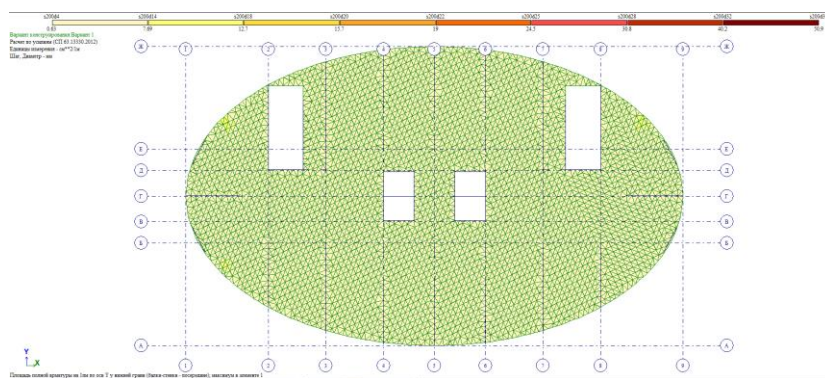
Схема армирования плиты перекрытия у нижней грани вдоль оси Y
